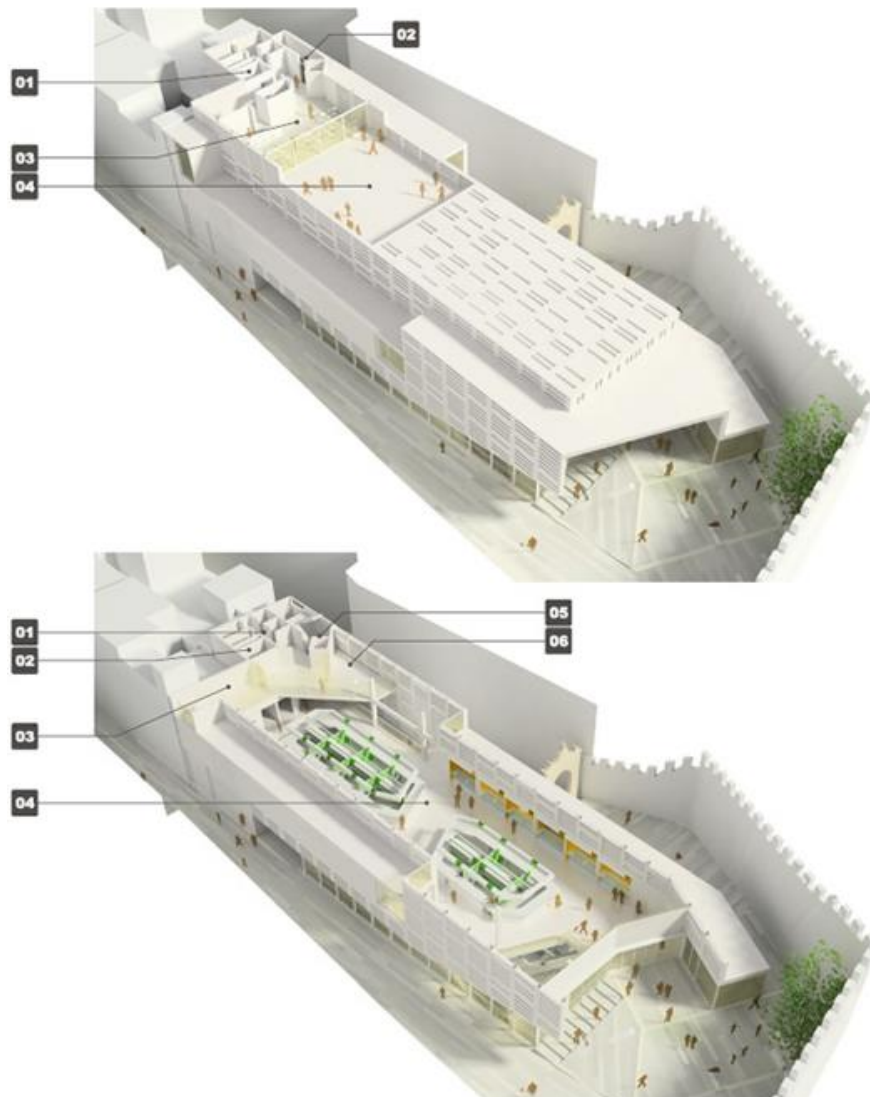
Planta del 1º y 2º piso del Mercado Sanlúcar
